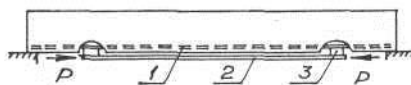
(1 - существующая арматура, 2 - дополнительная арматура, 3 - прокладки)
